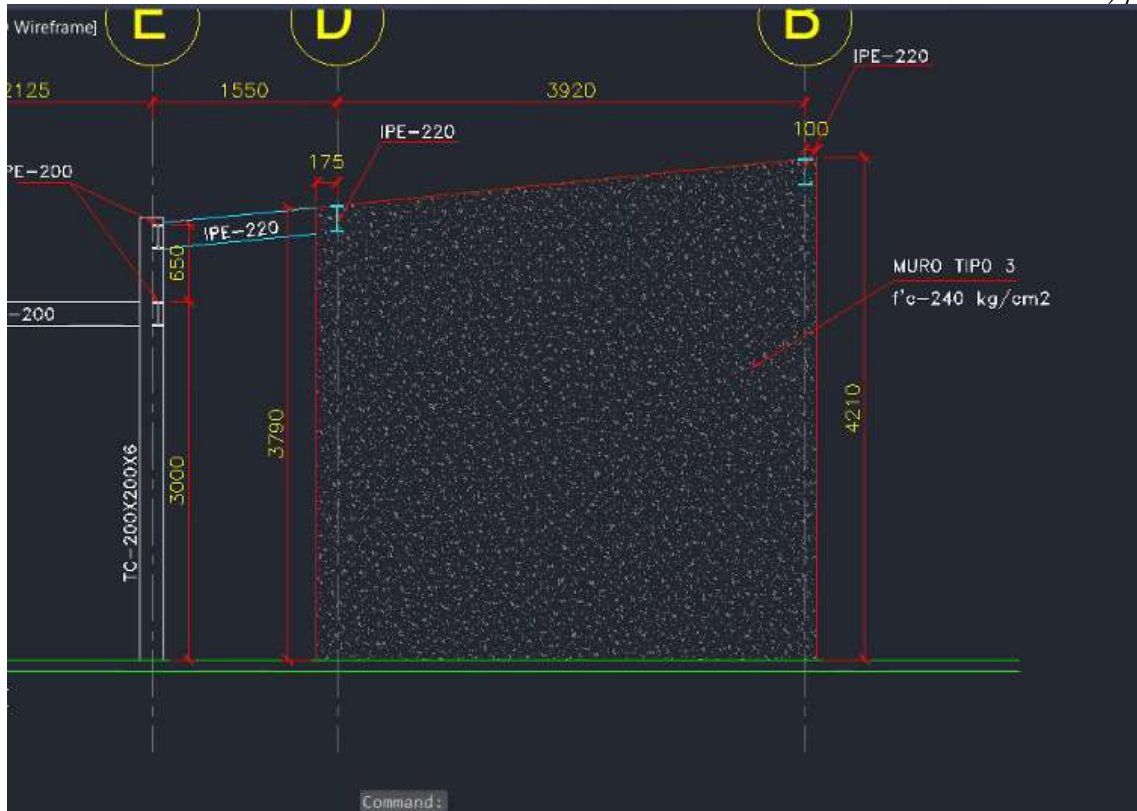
Dimensiones de muro de hormigón a encofrar.
